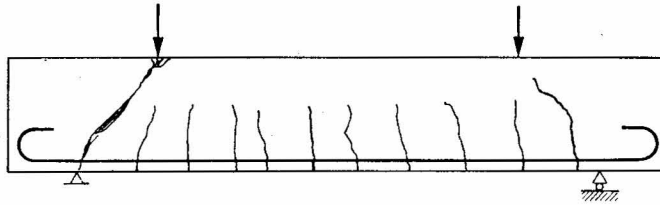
Fissuration d'une poutre mince lors de la rupture par coupe [65]
